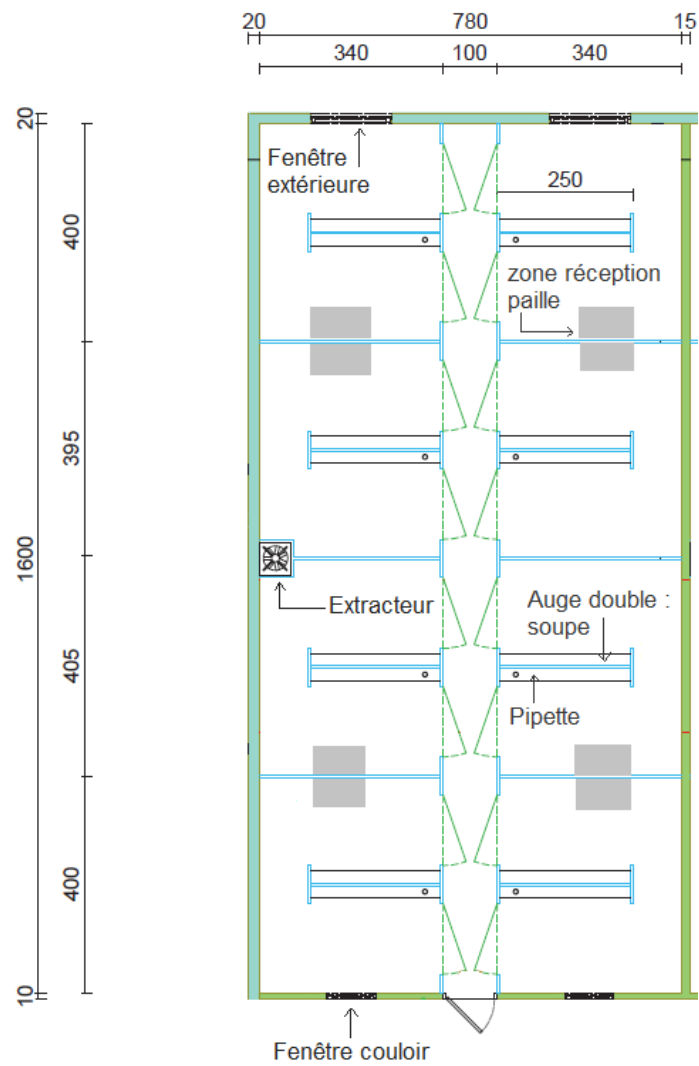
Plan d'une salle d'engraissement aux Trinottières
